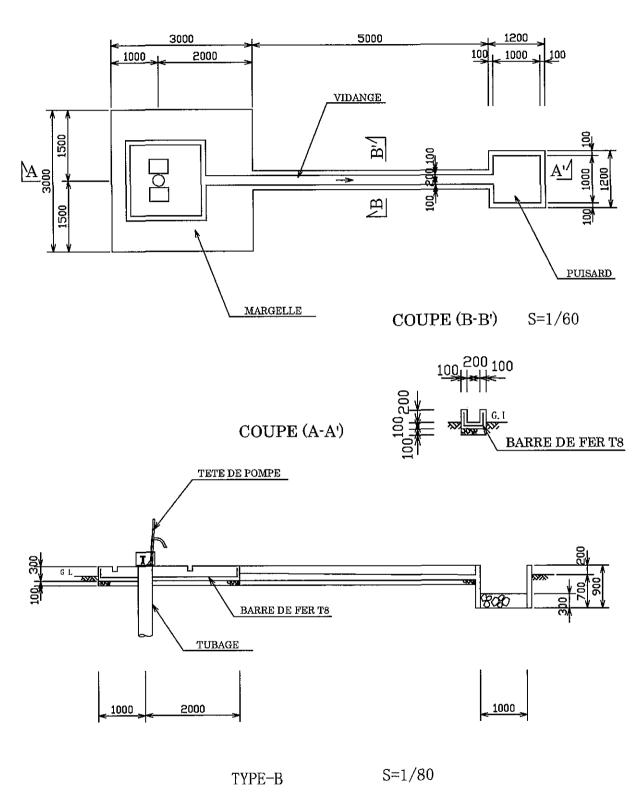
Structure standard des installations secondaires des forages (pompes a pedale)
